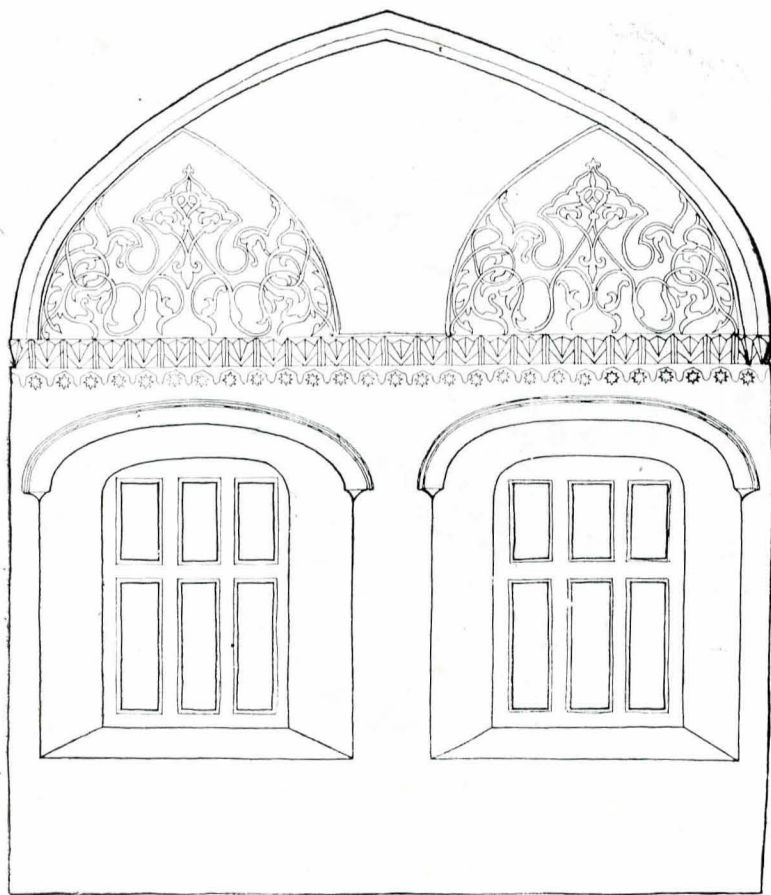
g. Conacul de la Măgureni. Fragment de pictură murală (reconstituire) din camera „B” a conacului.
